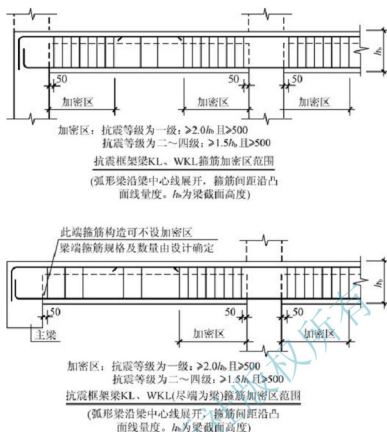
抗震楼层框架梁 KL 和屋面框架梁 WKL 钢筋构造 (续)
